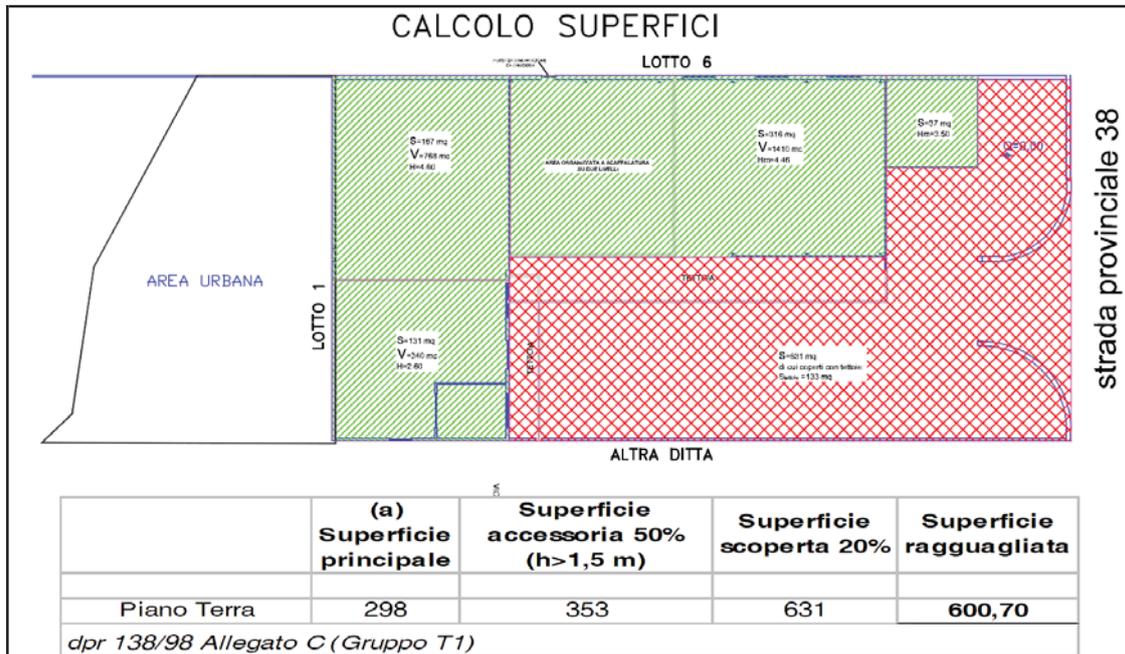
stralcio calcolo superfici lotto 2 Allegato 10
